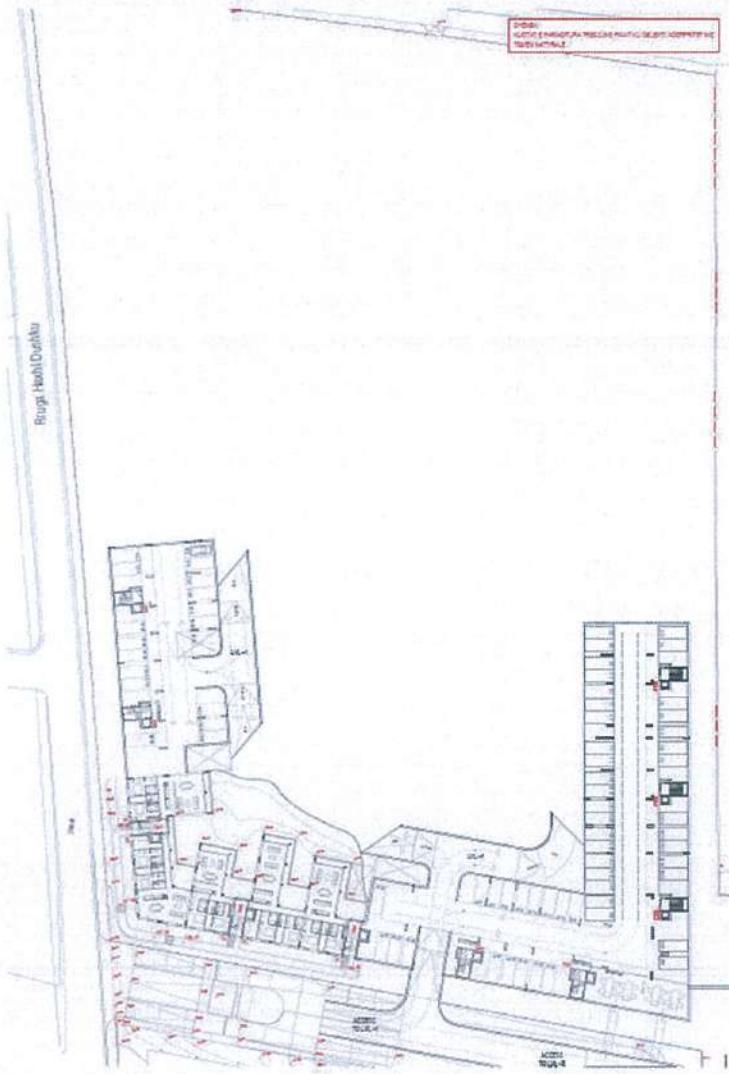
Planimetria e objektit verior në Kuotën +198.40
